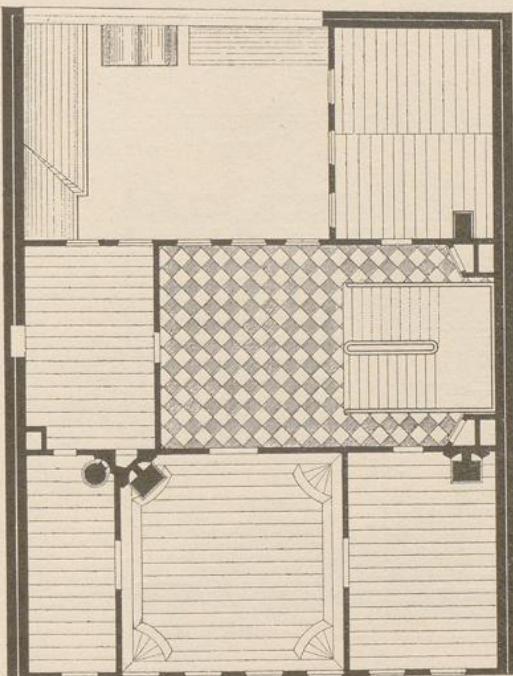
Goethe-Haus; Grundriss des I. Obergeschosses.
